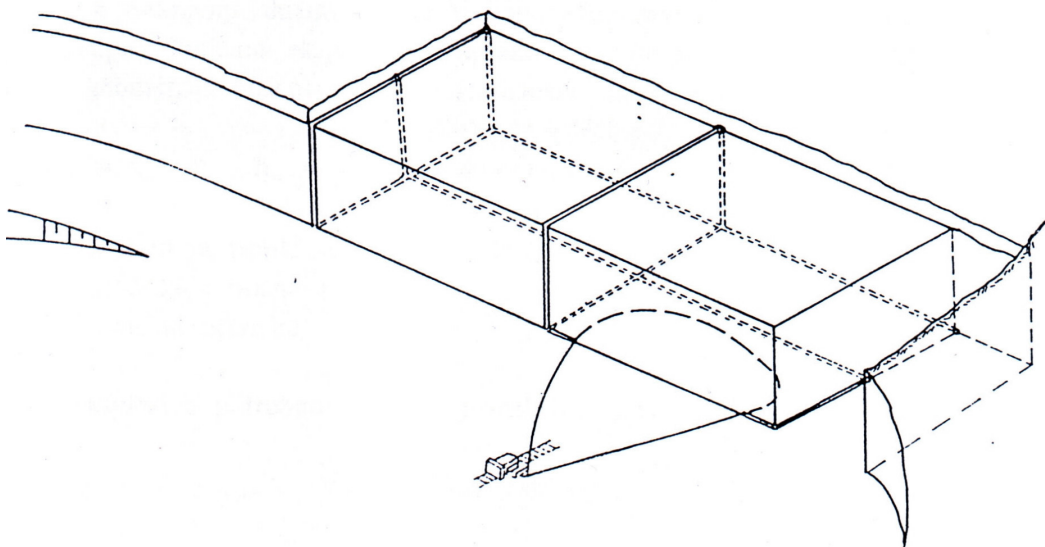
Primjer konstrukcije mine i shema vezanja minskog polja za slučaj s pješčanom zaštitom
